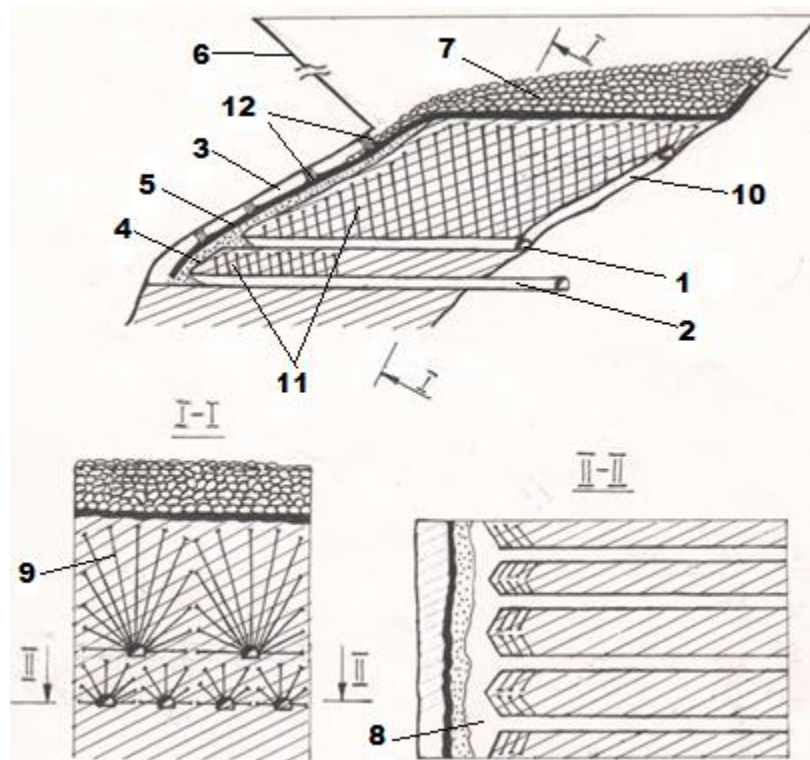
Технология обработки подкарьерных рудных тел с углублением горных работ: 1- буровая выработка, 2- доставочная выработка, 3- отрезная щель, 4-отбитая руда монтажного слоя, 5- гибкое разделяющее перекрытие, 6- карьер, 7- отвал пустых пород, 8- подсечка, 9- скважины, 10- наклонная выработка, 11- скважины, 12- временные целики
